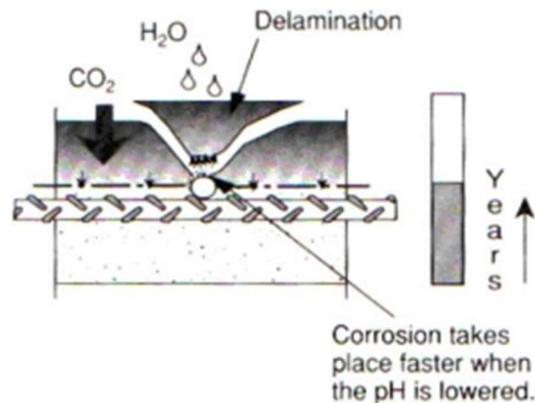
Descolamento do concreto após corrosão por carbonatação.
